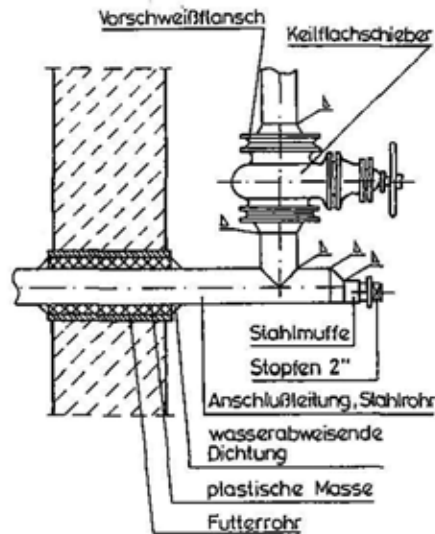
Hauseinführung ab Nennweite NW 80
